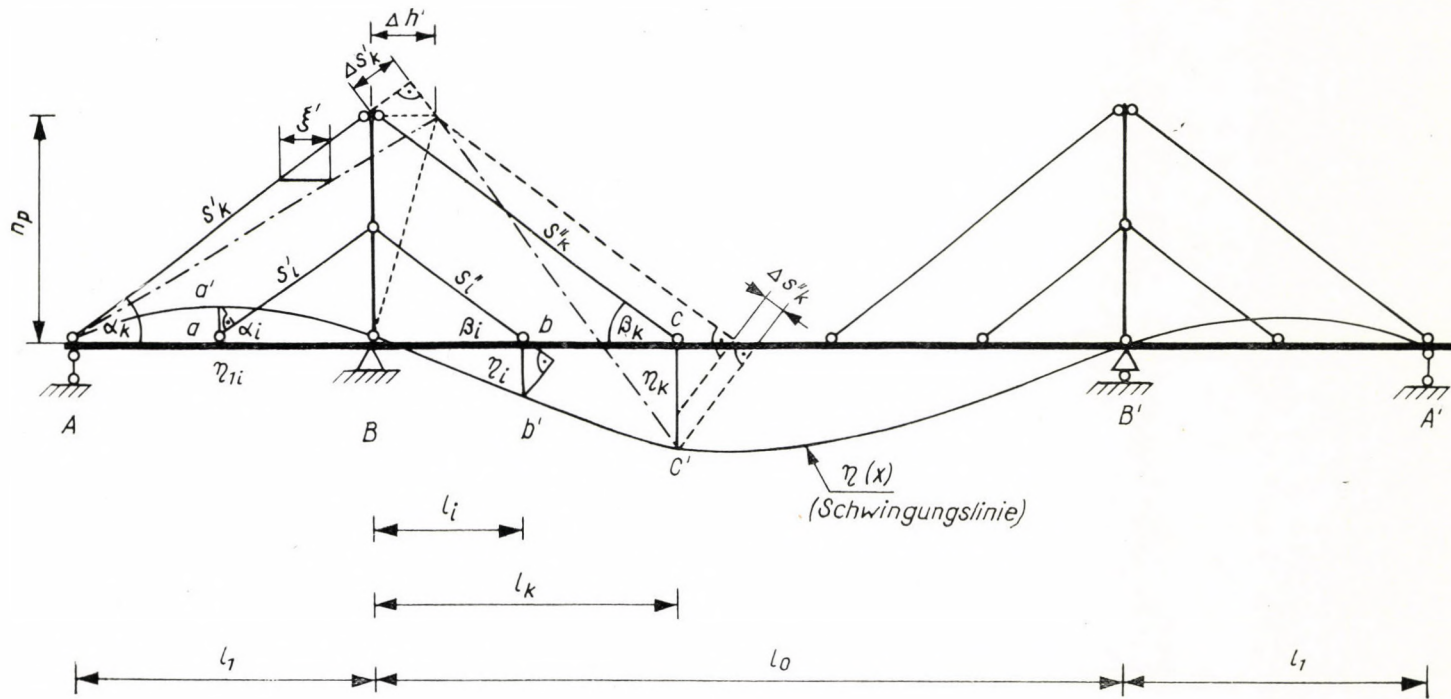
Grundsystem einer Schrägseilbrücke mit durchlaufendem Versteifungsträger und bewegbaren (gelenking gelagerten) Pylonen
